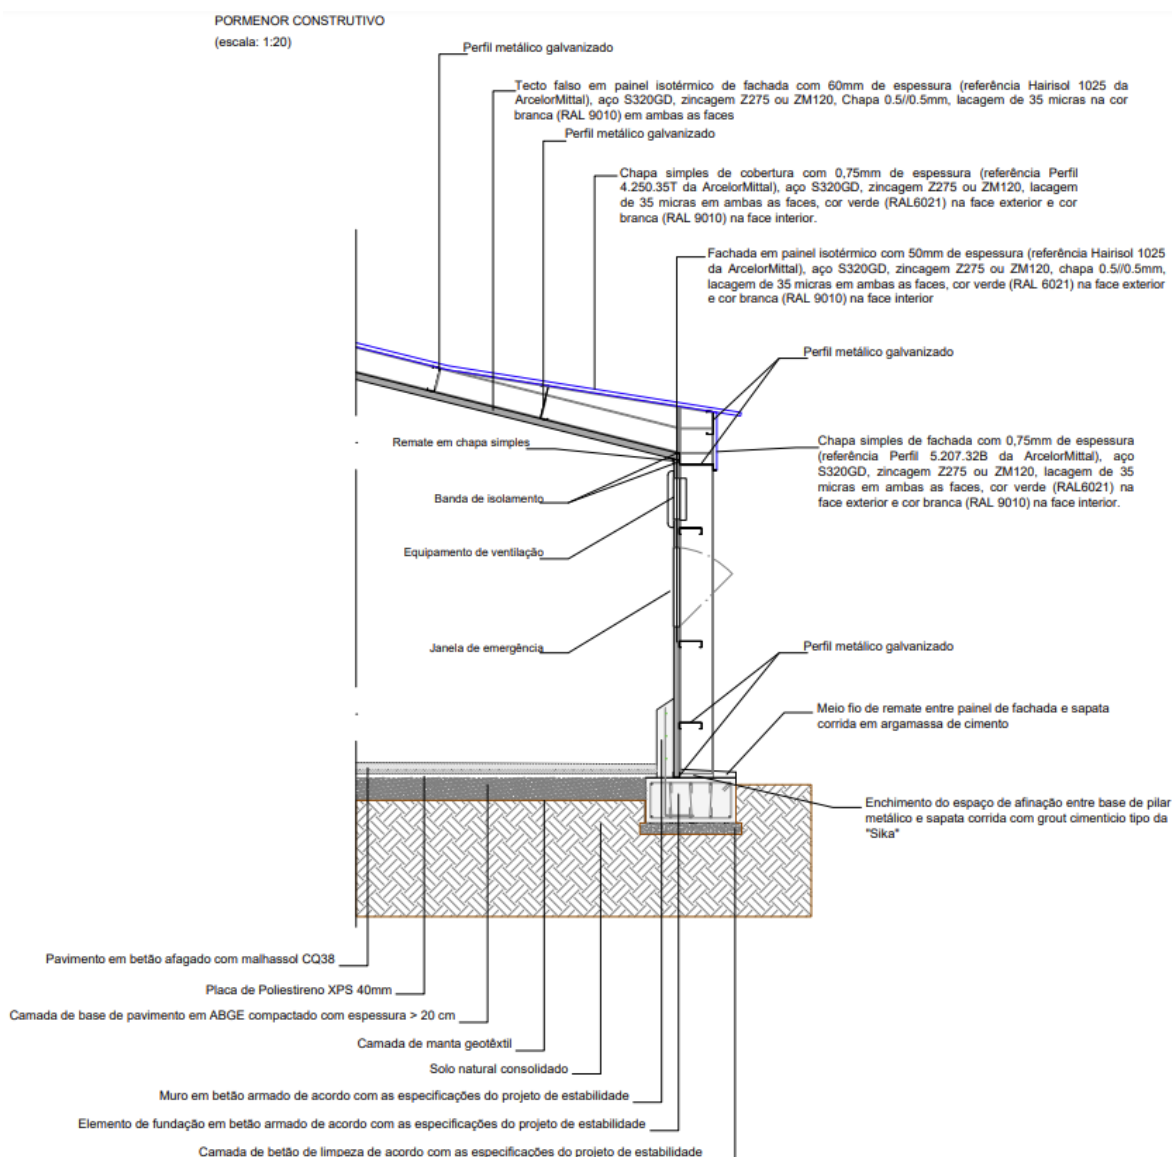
Pormenor construtivo dos pavilhões avícolas.
